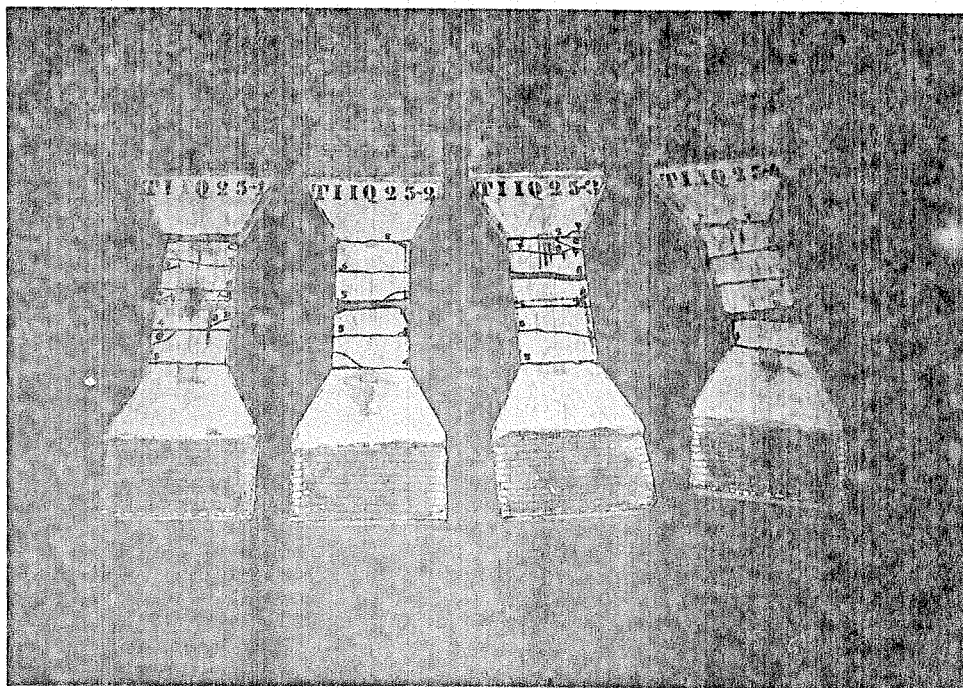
Fissuração final - Série TI1025 (face 2 - regiões C e D)
